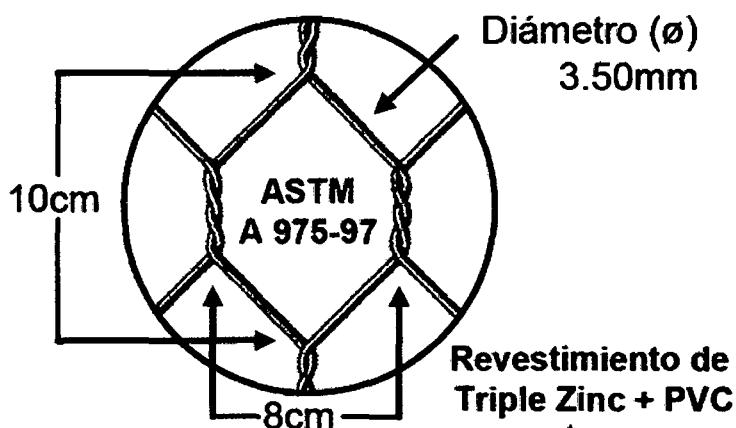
Gavión tipo caja o colchón antisocavante plastificado
